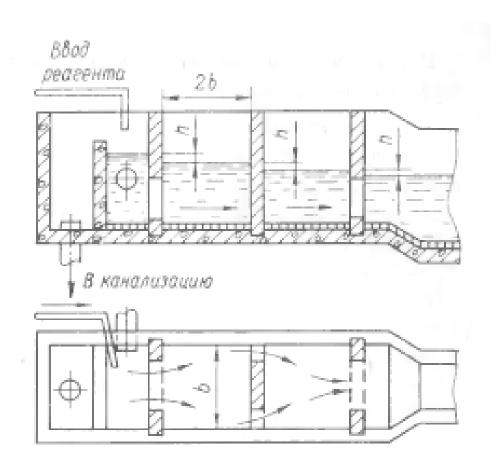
Перегородчатый смеситель (схема устройства)
